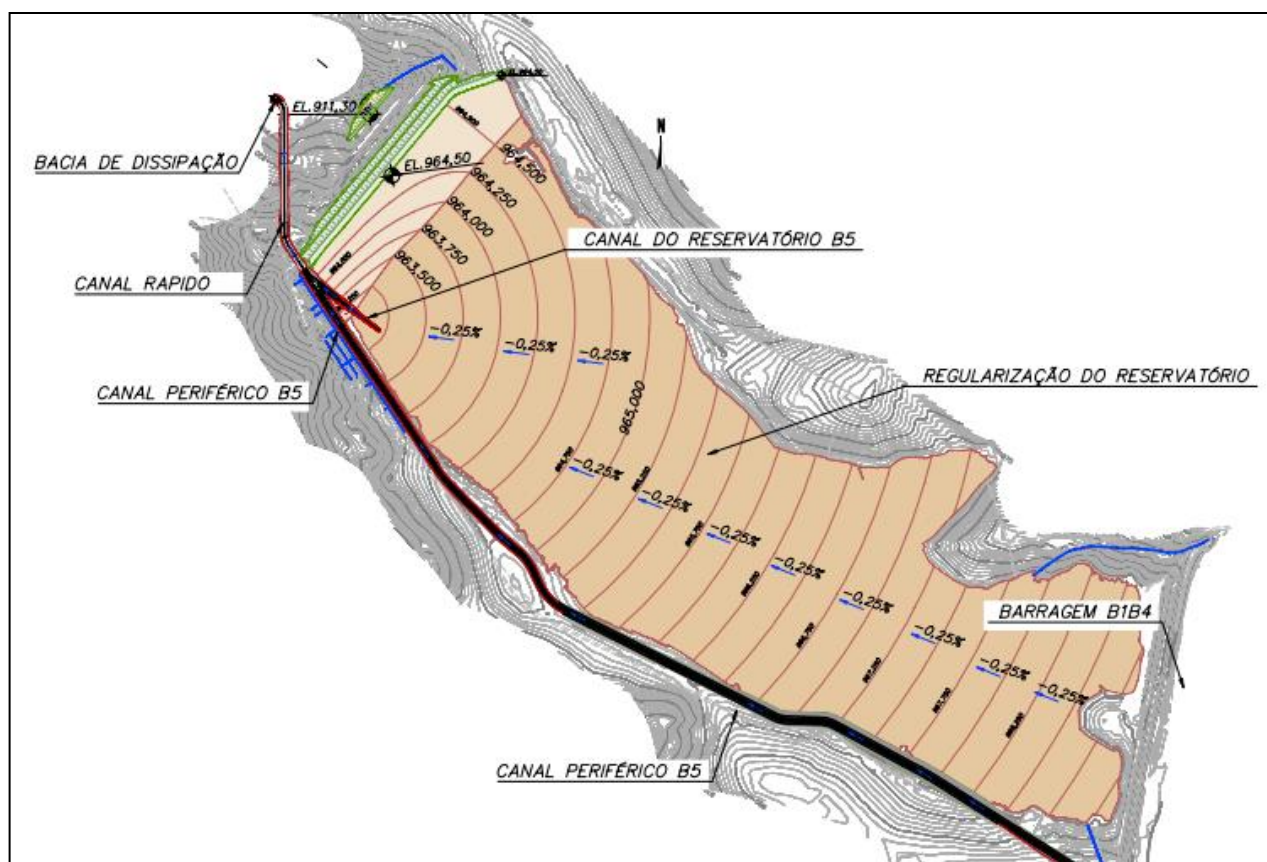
Arranjo geral das estruturas de drenagem superficial propostas para o projeto.
